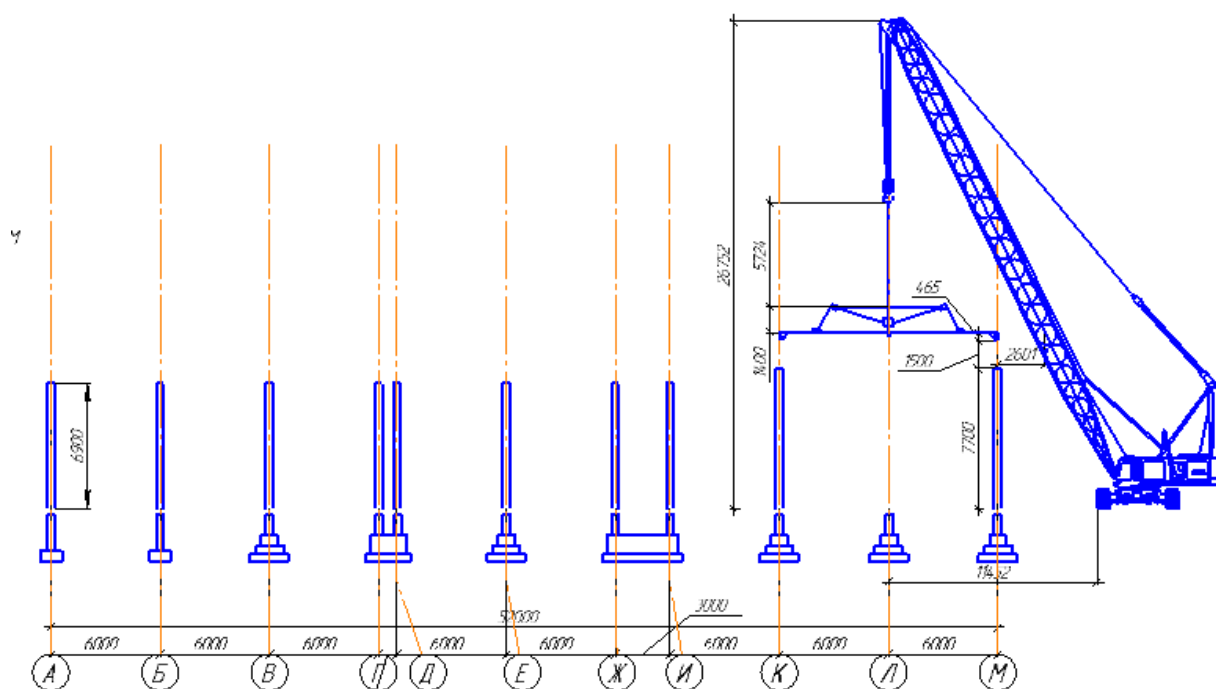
Монтаж плиты покрытия над лестничной клеткой.
